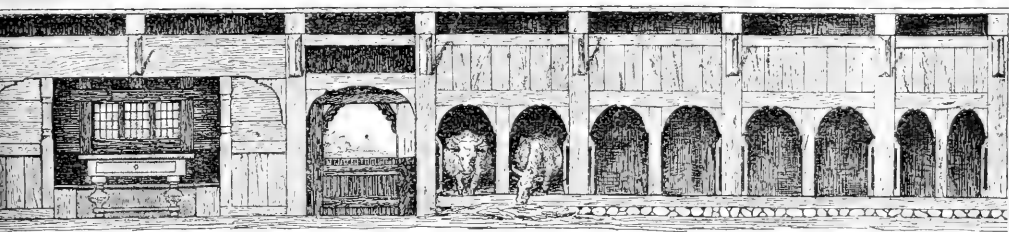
Coupe en long du rez-de-chaussée d'une construction rurale à Ostenfeld.
